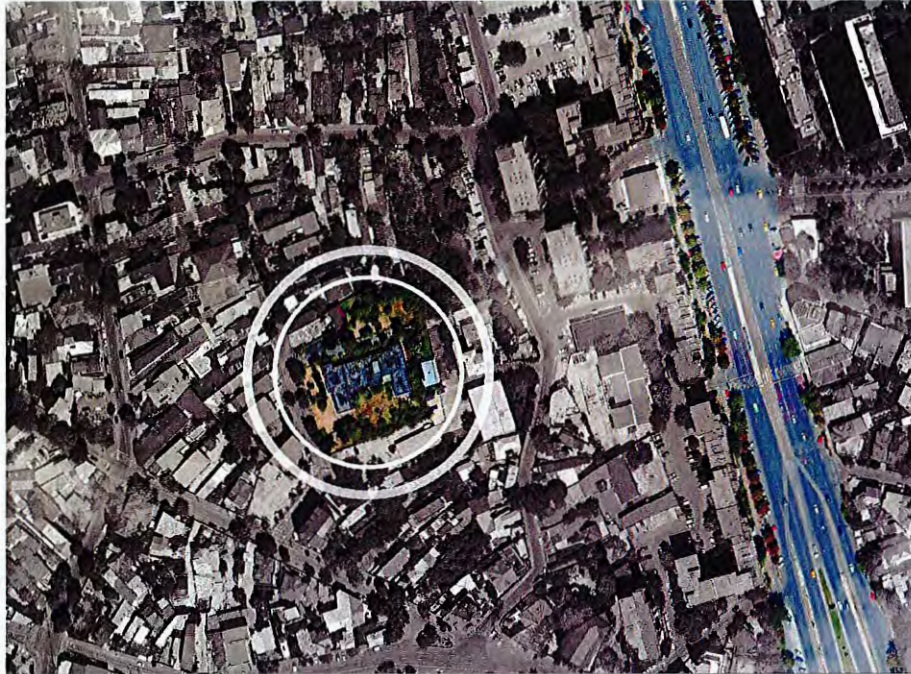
Plan de amplasare în zonă a terenului pe care urmează a se realiza investiția
